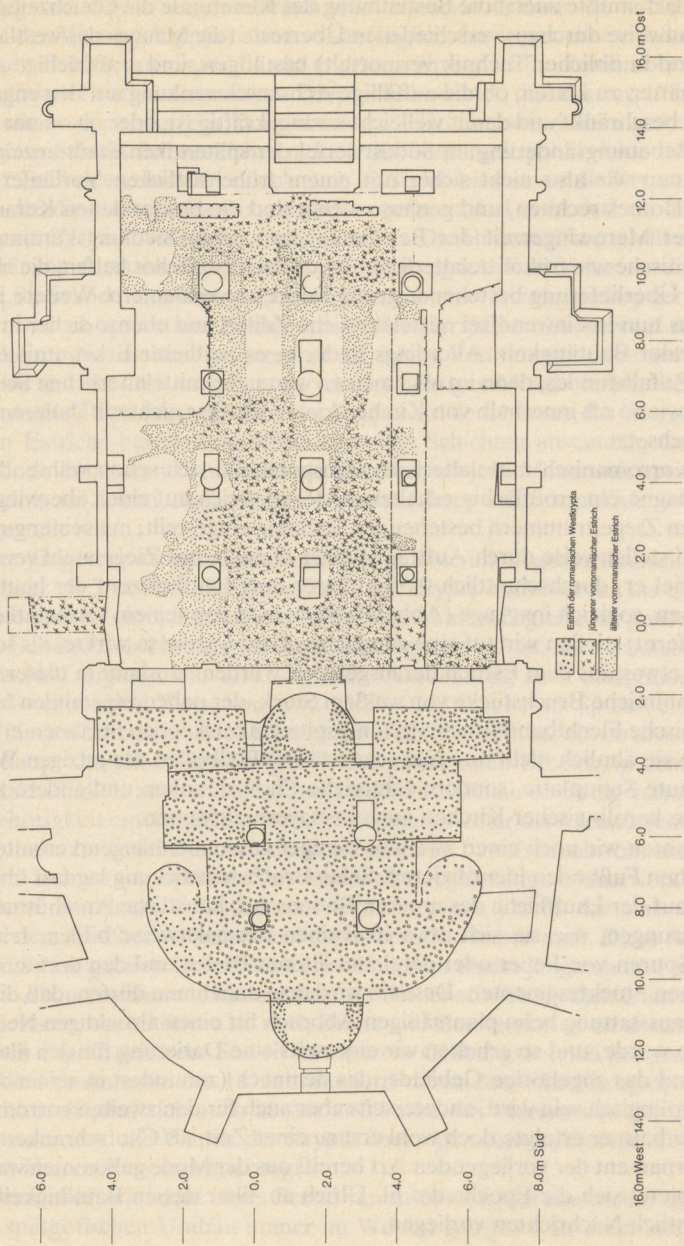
Abb. D. Augsburg, Domkrypta. Plan der mittelalterlichen Befunde. M. (jetzt) 1:50
